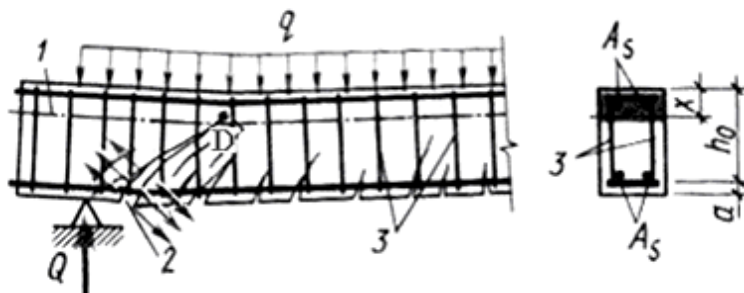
Схема руйнування вигнутого елемента по похилому перерізу від переважаючої дії вигинаючого моменту: 1 – нульова лінія, 2 – похила тріщина, 3 – хомути
